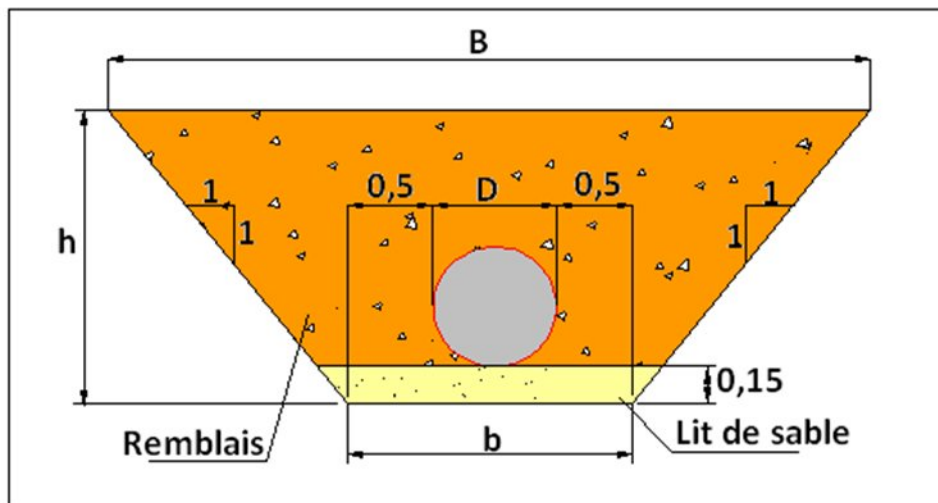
Coupes en travers de la tranchée de la conduite.
